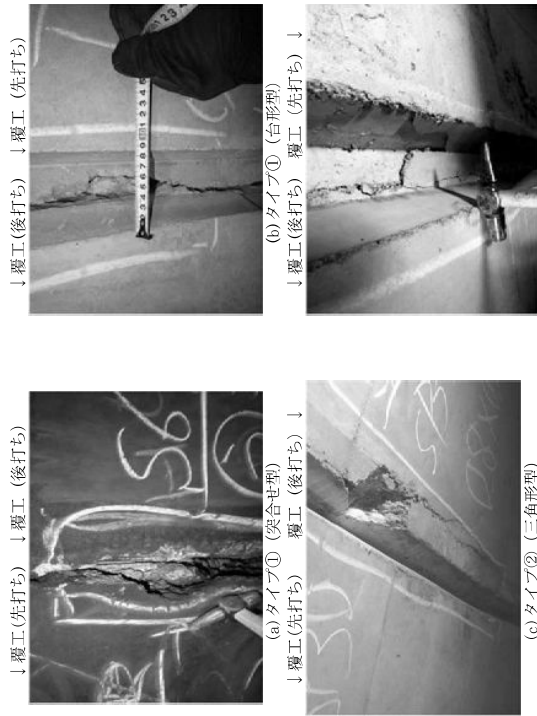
横断目地付近で発生するひび割れ等の例²⁾
